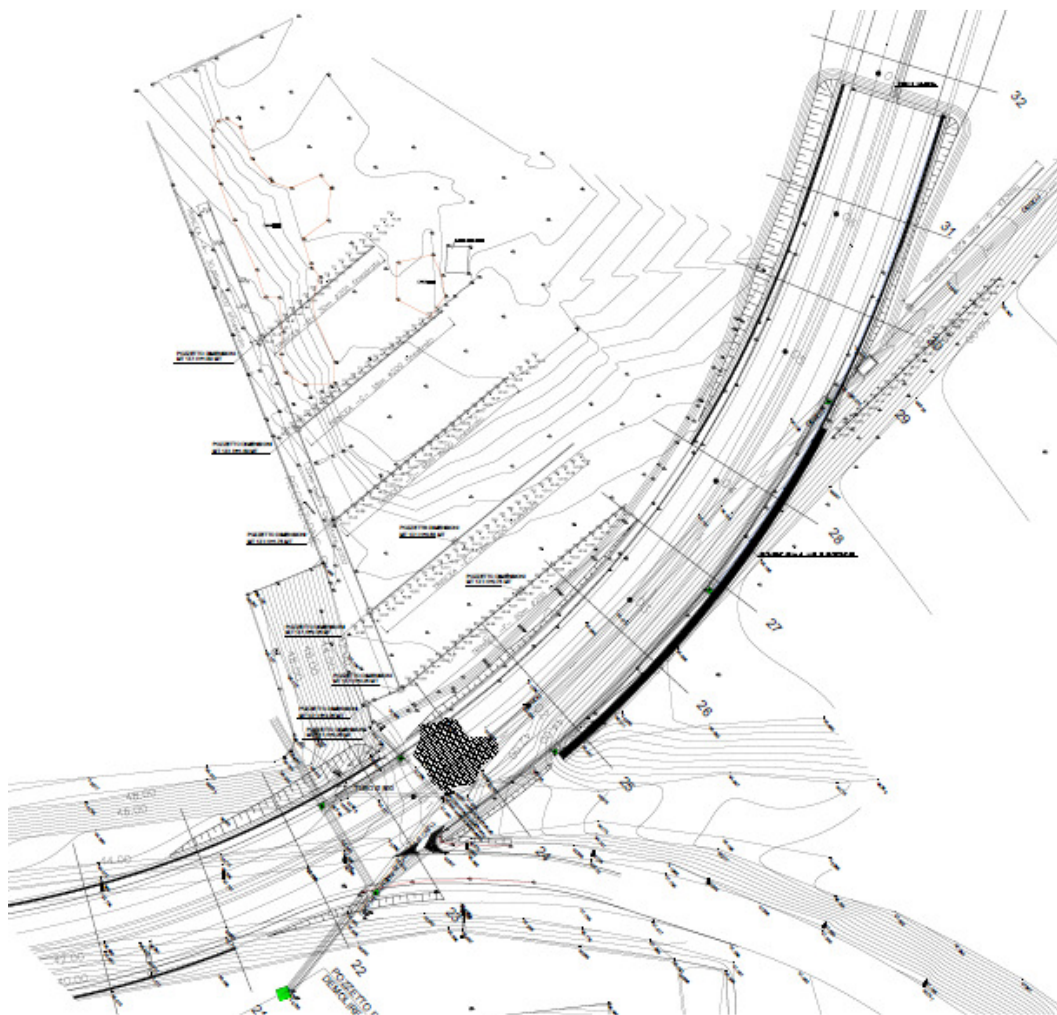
PLANIMETRIA TRINCEE DRENANTI
